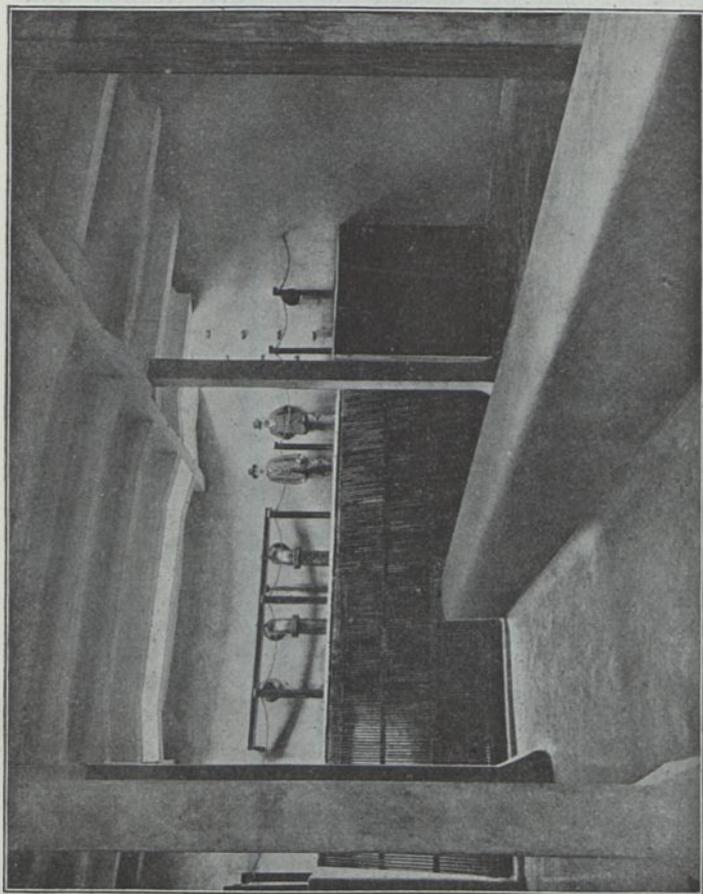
Rechenanlage und Sandfang der Kanalisation von Eberswalde.
